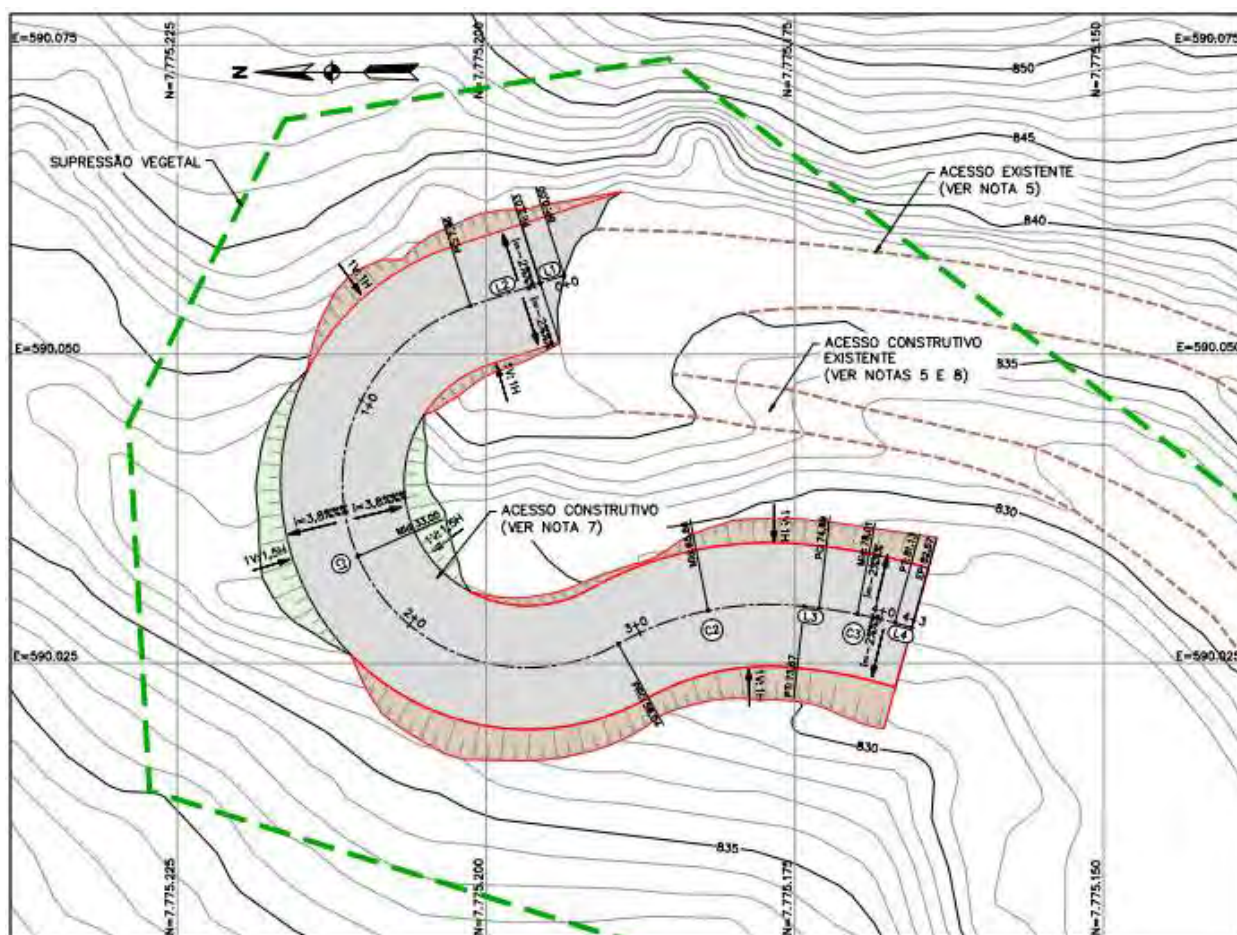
Acesso Construtivo – Planta (Fonte: 1850JJ-X-31343 – BVP)
